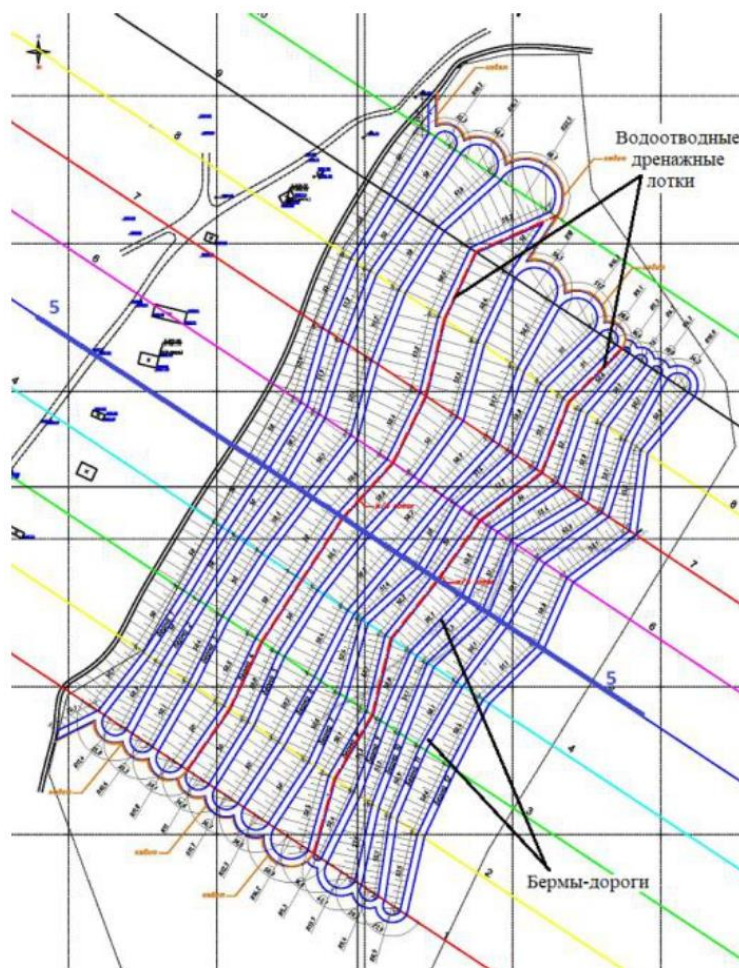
План бермы-дороги и дренажных канав на оползневом участке
